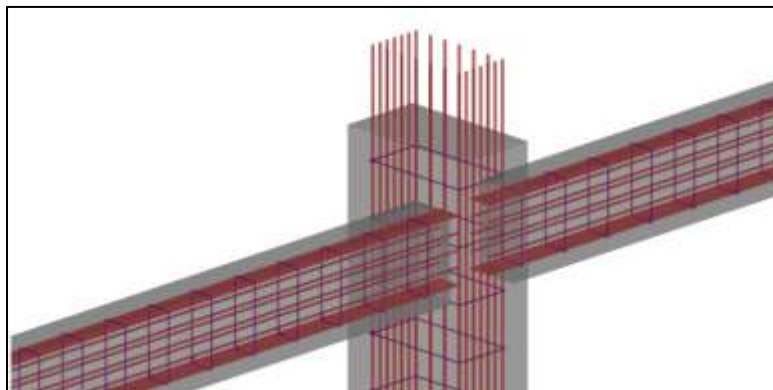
Esquema de viga y columna. Fuente: El Autor (2023)
